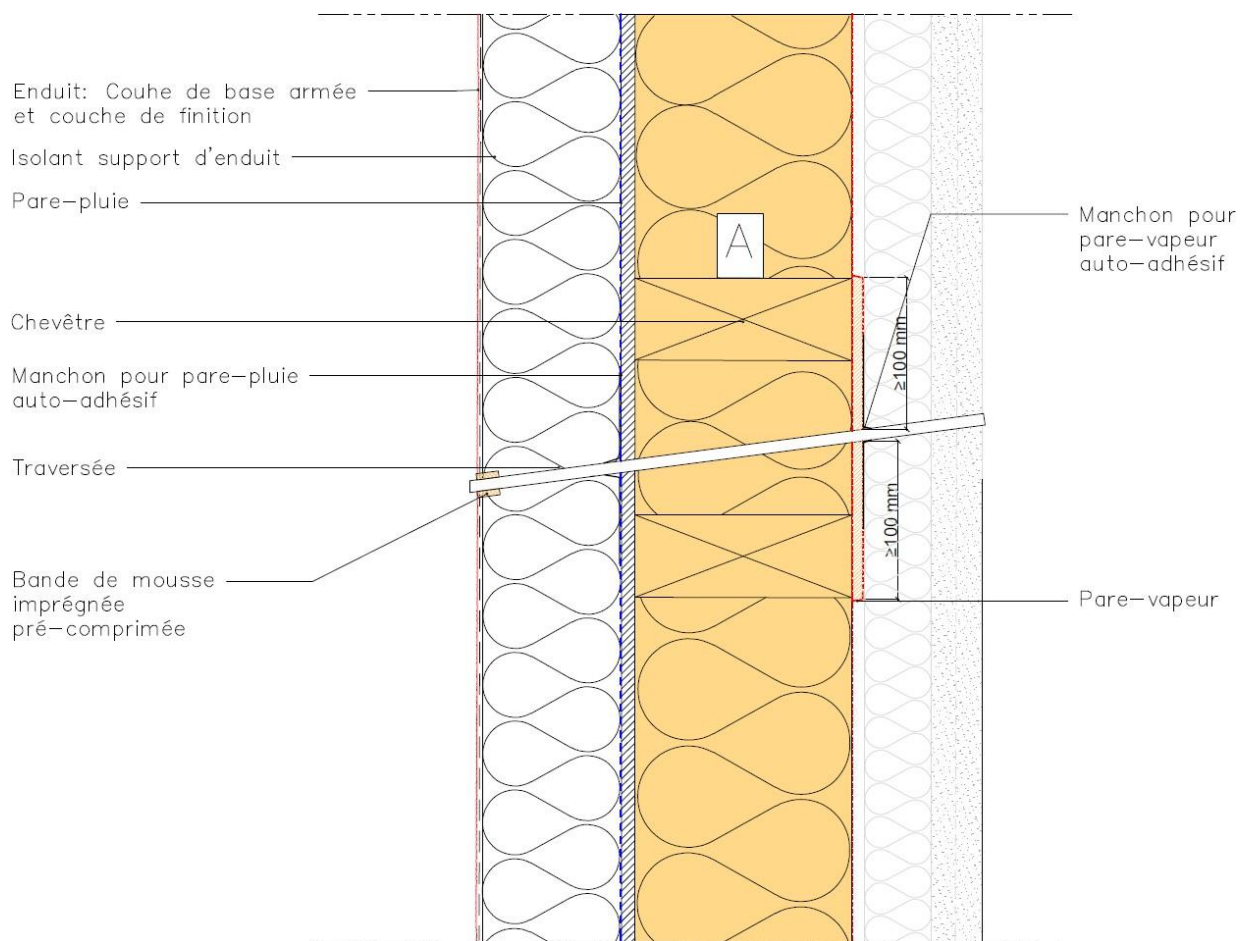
Traversée de paroi – Type passage de câble - Coupe Verticale
